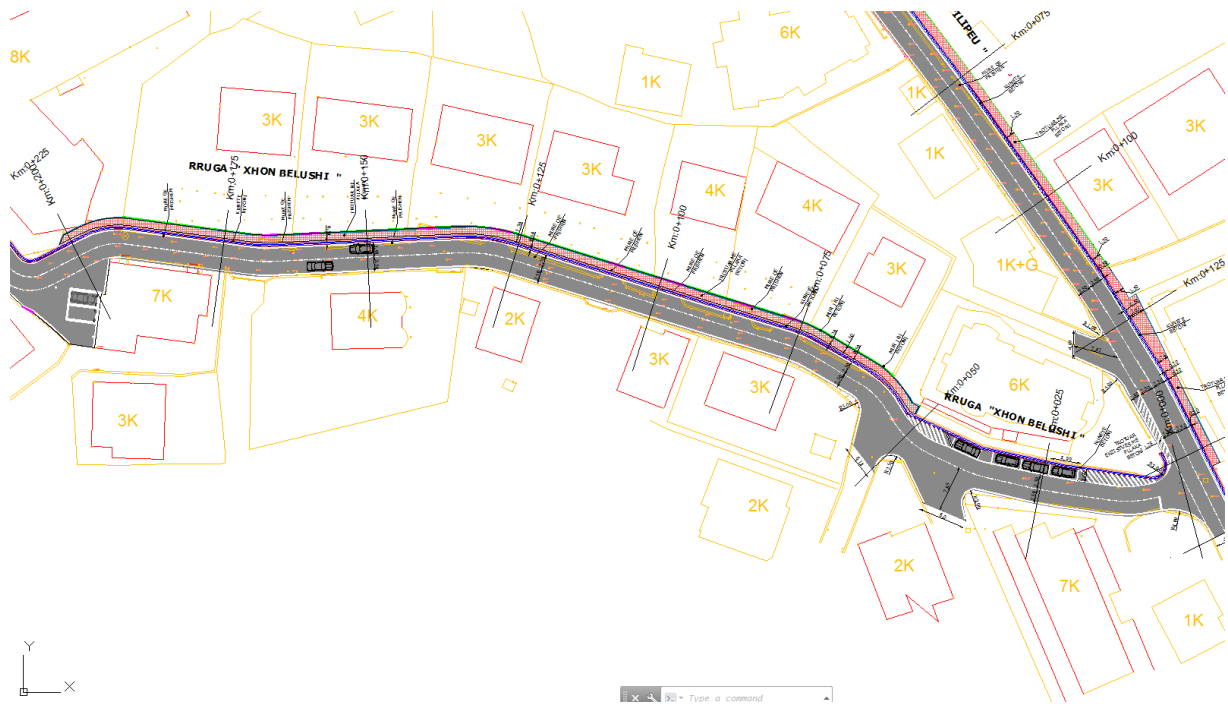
Plane te Planimetrise se rruges “Xhon Belushi”
